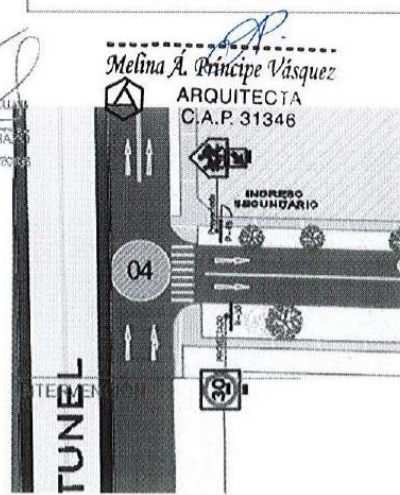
Intersección 04 de la IE "Santa Rosa", entre la Calle San Juan y la Av. Panamericana.
